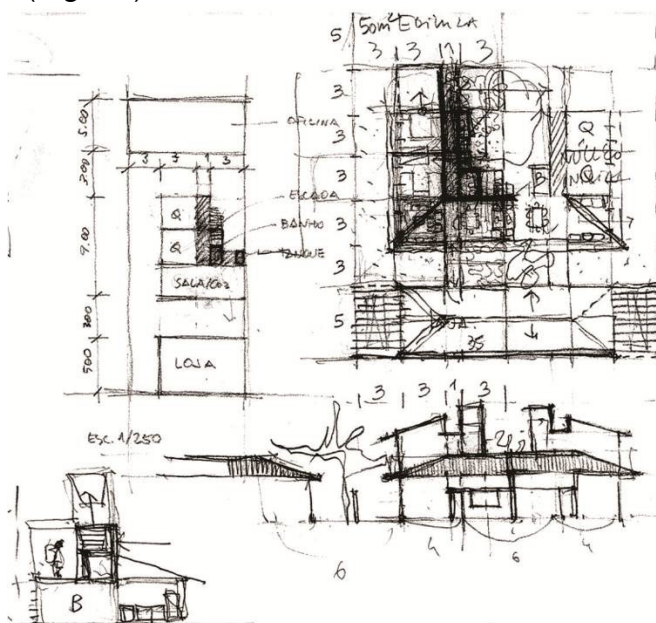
Estudo por croquis em planta, corte e elevação das unidades no terreno. Fonte: equipe de projeto.
